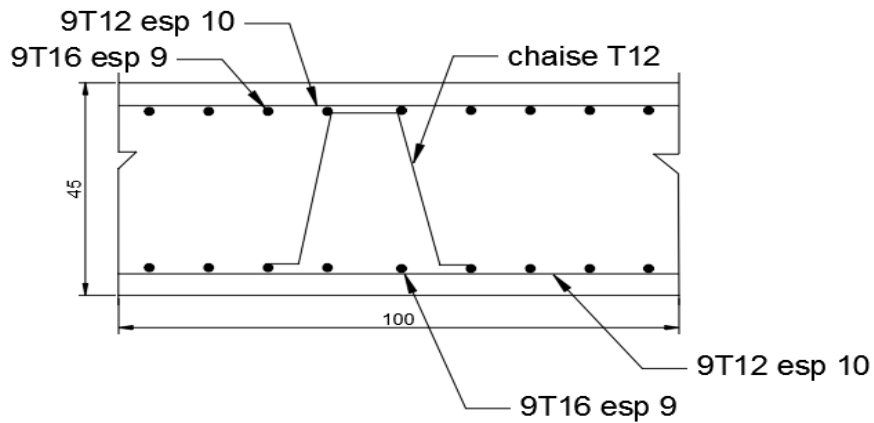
Ferrailage de la dalle du radier sur travée sens X-X (cm).
